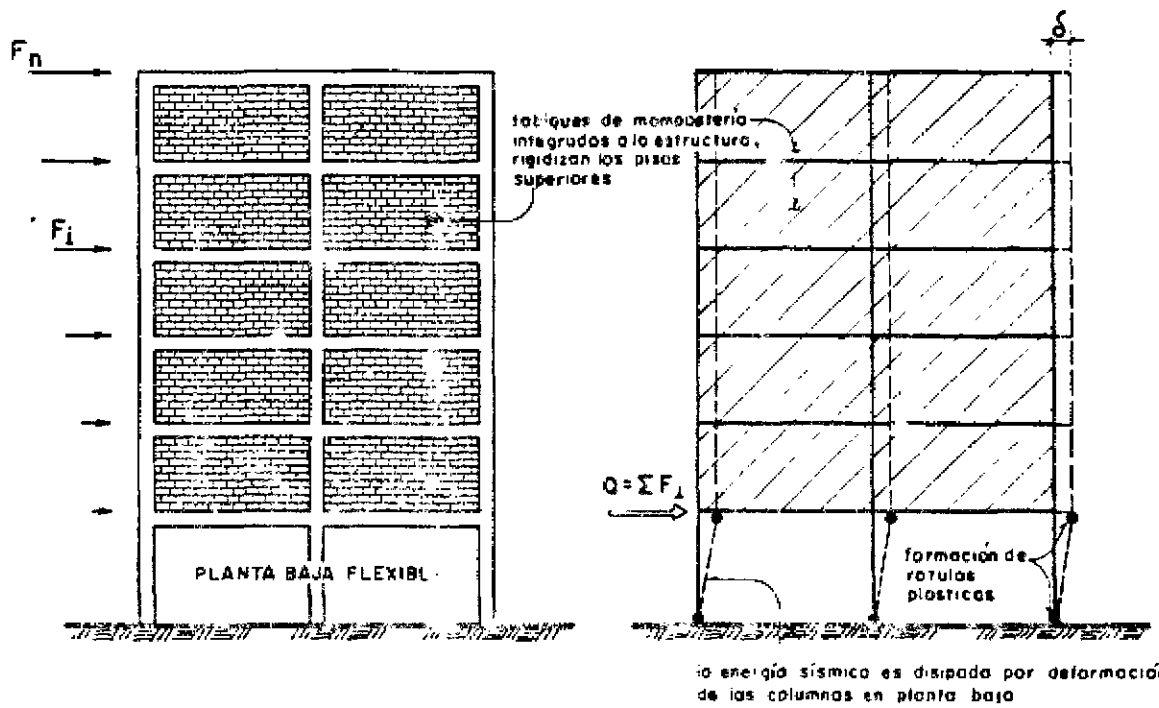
Edificio con planta baja flexible y pisos superiores rigidizados por mampostería. La energía sísmica es disipada por deformación de las columnas de la planta baja, pudiendo conducir a un mecanismo de colapso.
